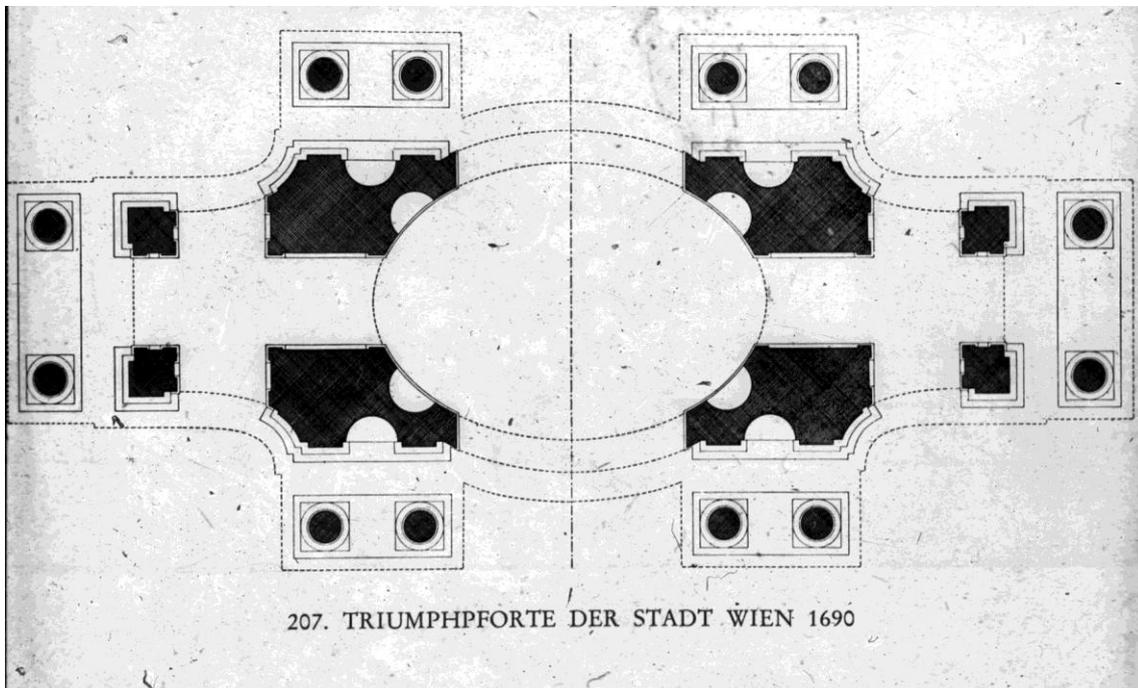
J.B. Fischer von Erlach, Grundriss der Ehrenpforte in der Wollzeile, 1690
